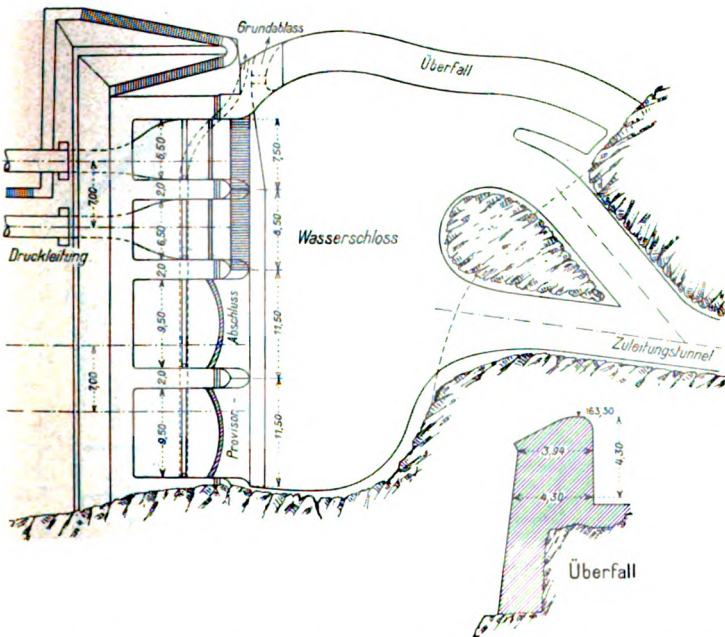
Grundriss des Wasserschlosses. — Masstab 1:800 (Überfall 1:400).
